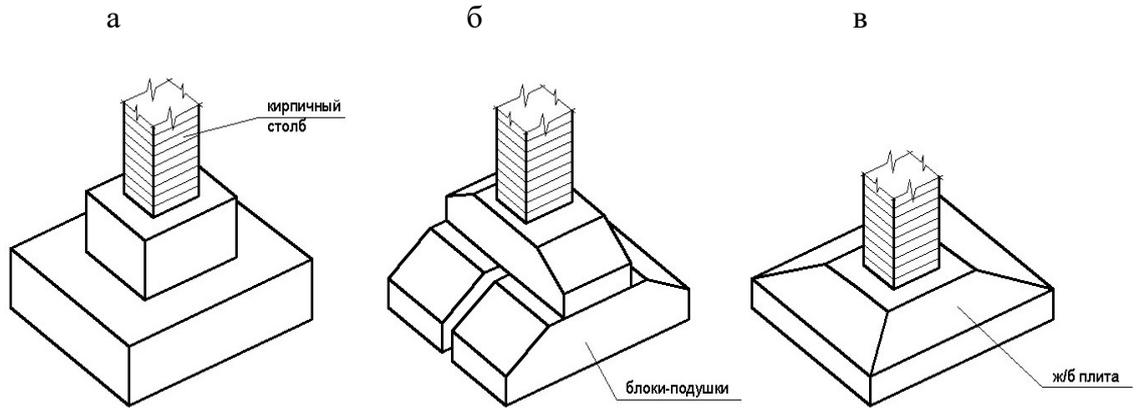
Столбчатые фундаменты под кирпичную колонну: а – монолитный; б – сборный из железобетонных блоков-подушек; в – сборный из железобетонного блока-плиты
